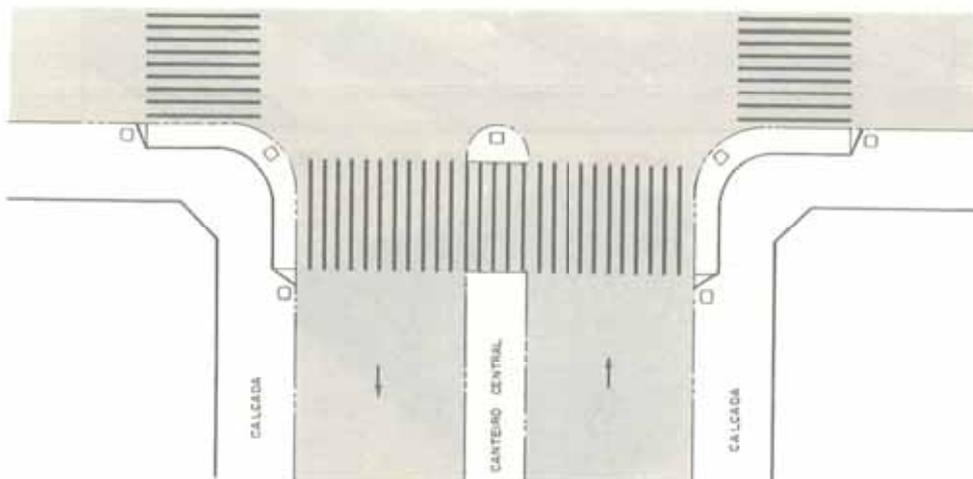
ESQUEMA DE REBAIXAMENTO DE GUIAS EM VIAS COM CANTEIRO CENTRAL — CRUZAMENTO
